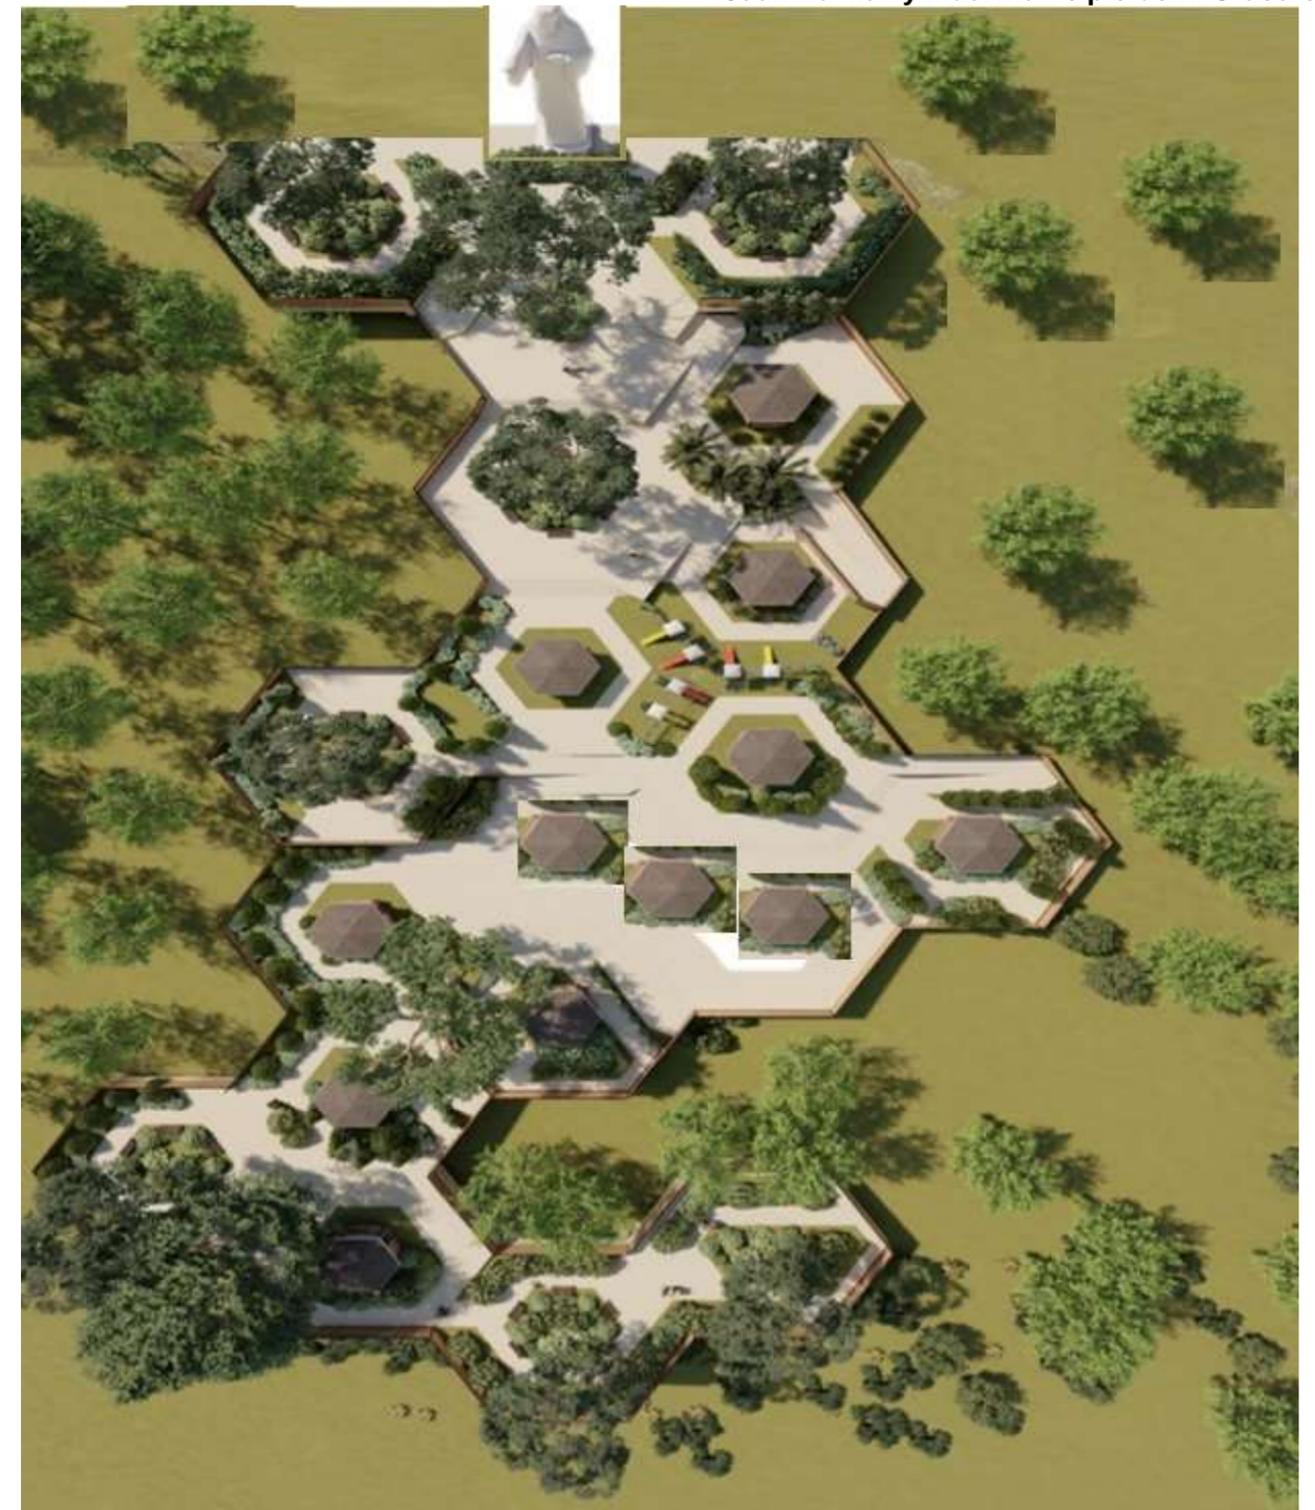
Planta arquitectónica mirador. Elaboración propia 2022
